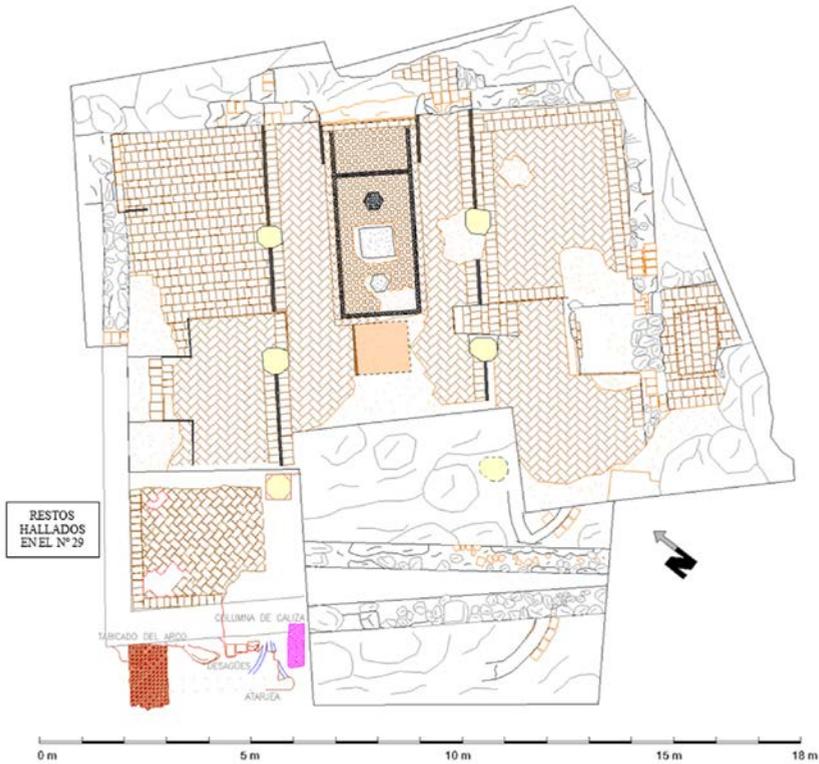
Planimetría de la excavación. La esquina oeste en la planimetría corresponde a los restos hallados en el inmueble nº 29 (memoria de excavación según Caballero y Sánchez, 2006)
